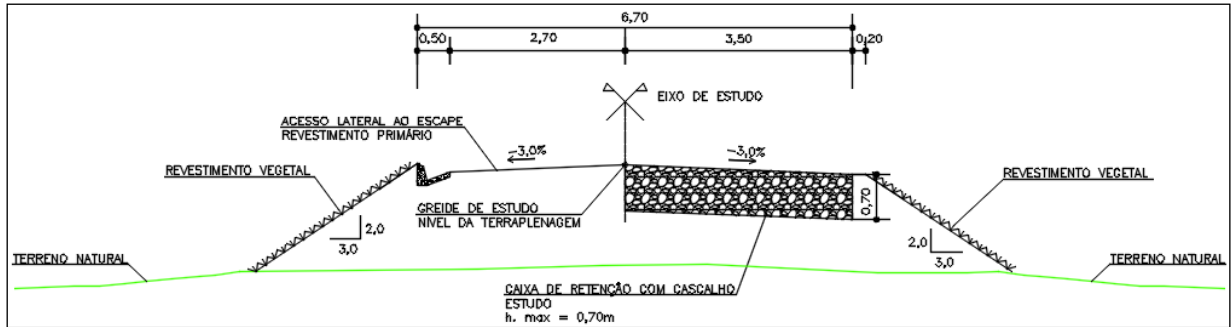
Rampa de Escape – Seção Transversal Tipo em Aterro.
